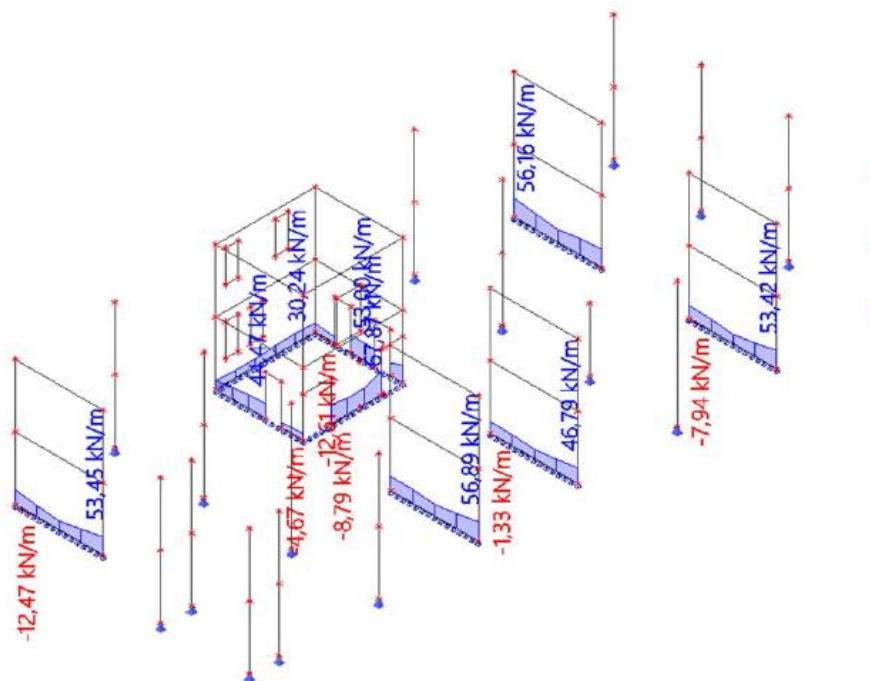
půdorys 1.NP konstrukčního systému – model B
